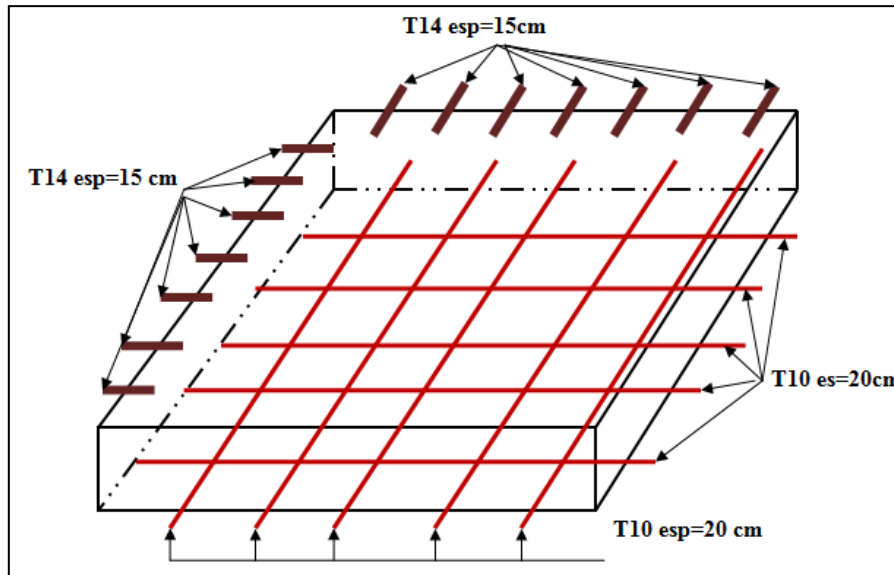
Disposition d'armatures de la dalle pleine terrasse inaccessible
